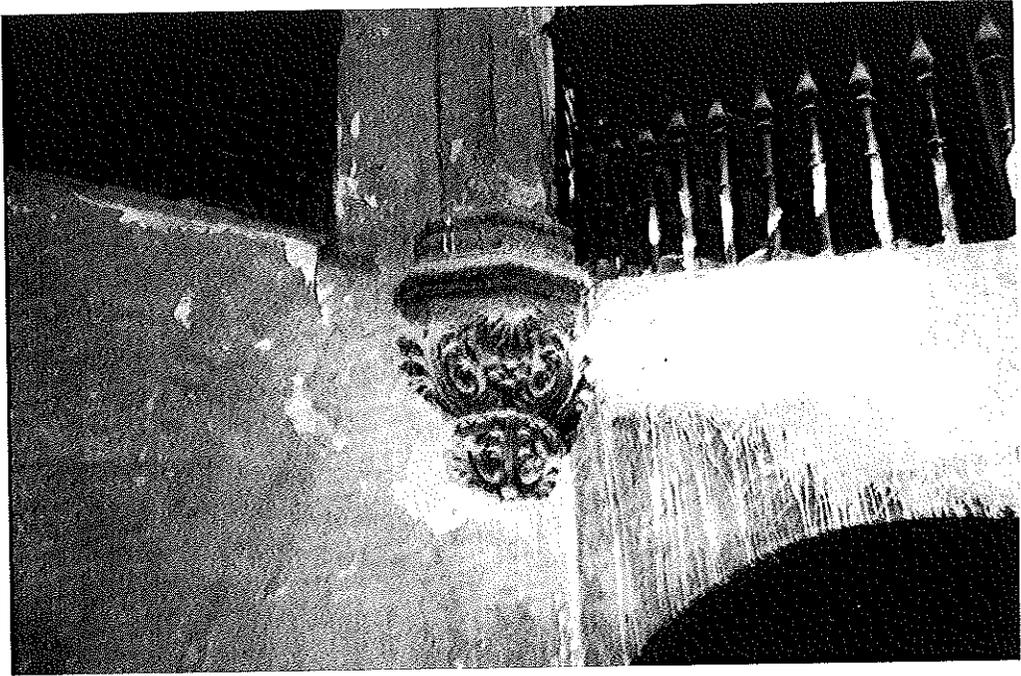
Ménsula de los pilares de la planta superior de la escalera.
